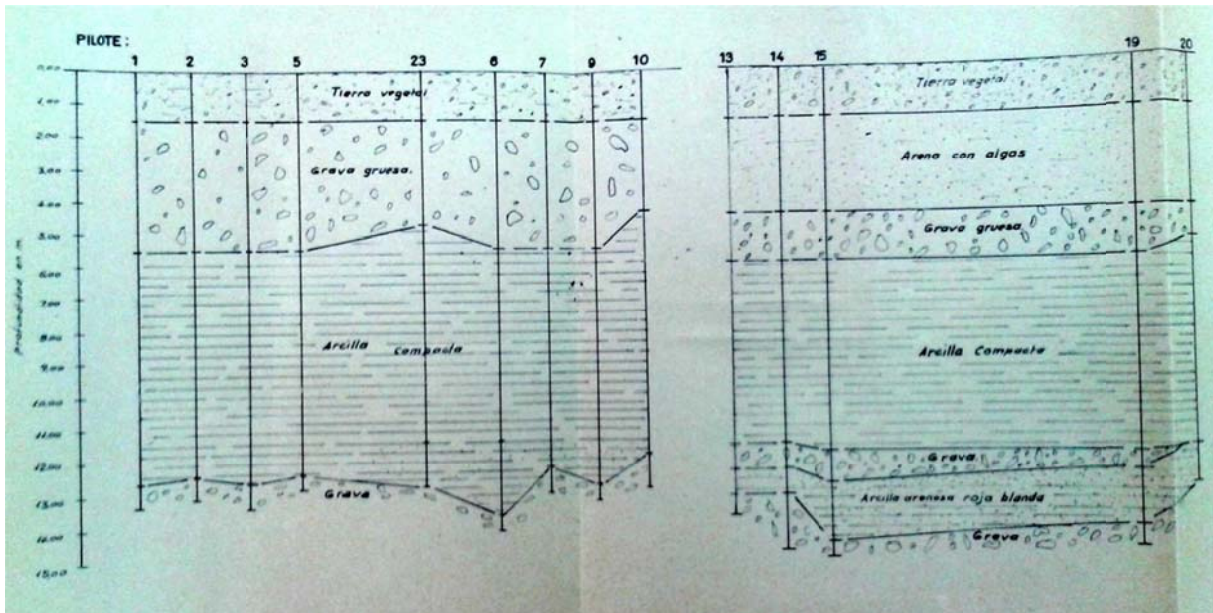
Estratos de cimentación 2. (Sondeos Inyecciones Pilotes, S.A., 1960)
